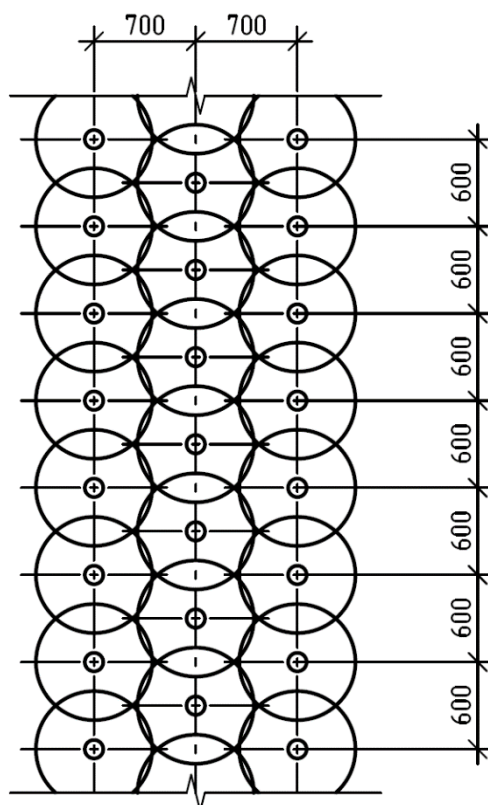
План расположения грунтоцементных элементов вертикальной противофильтрационной завесы
